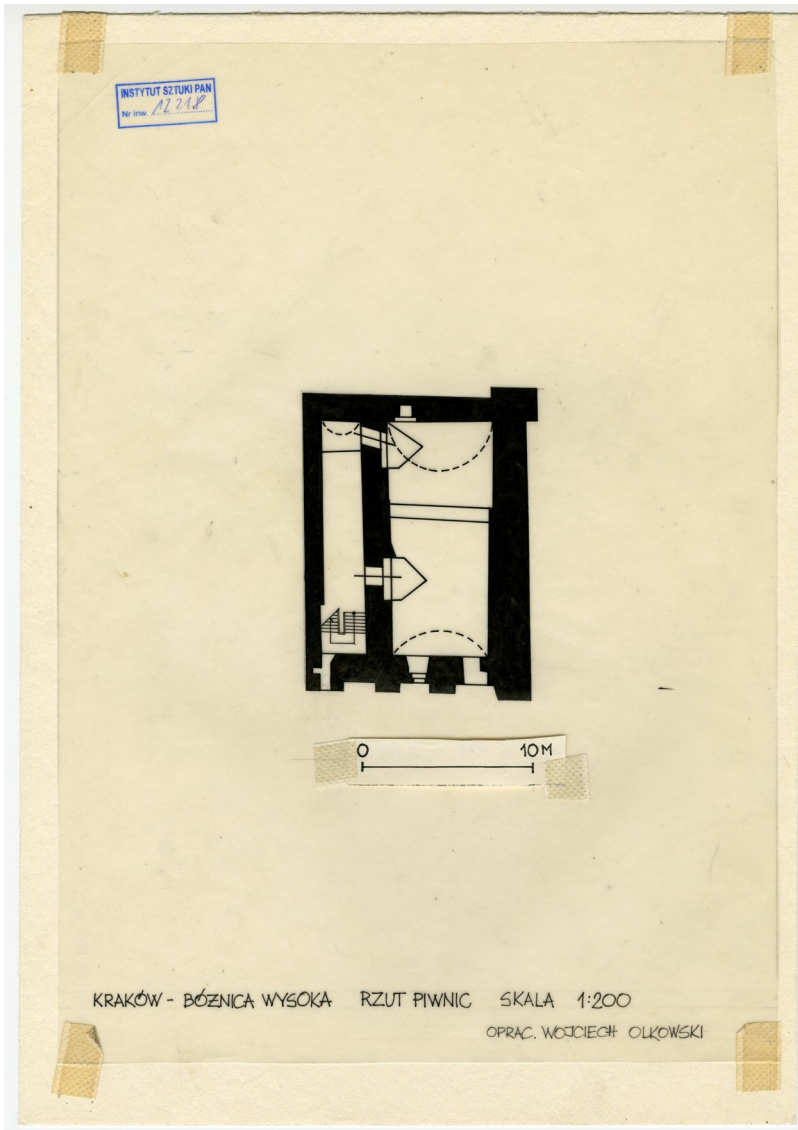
Grundriss KG, 1960er Jahre
